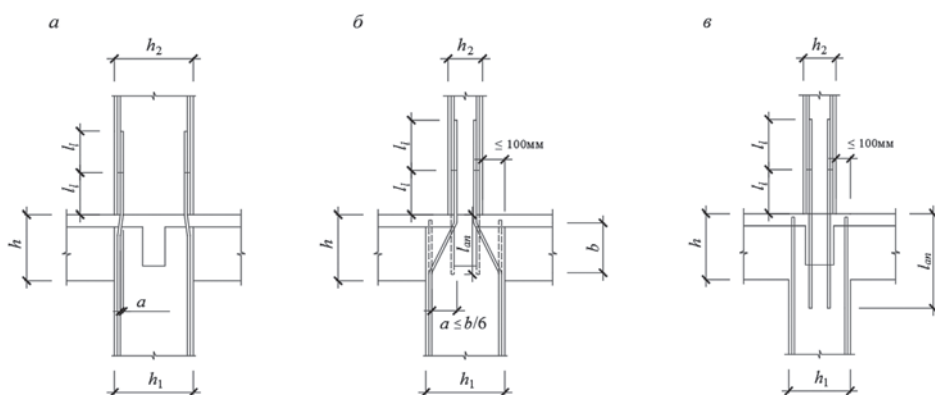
Схема устройства стыков продольной рабочей арматуры монолитных колонн многоэтажных зданий:
